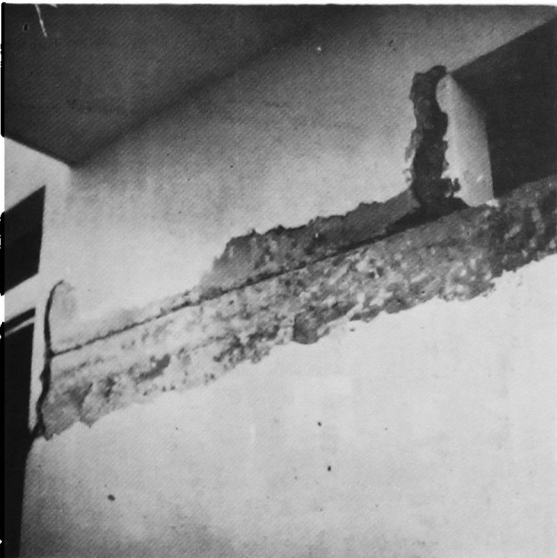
Detalle de grieta en junta de hormigonado. Edificio de Carabineros.
